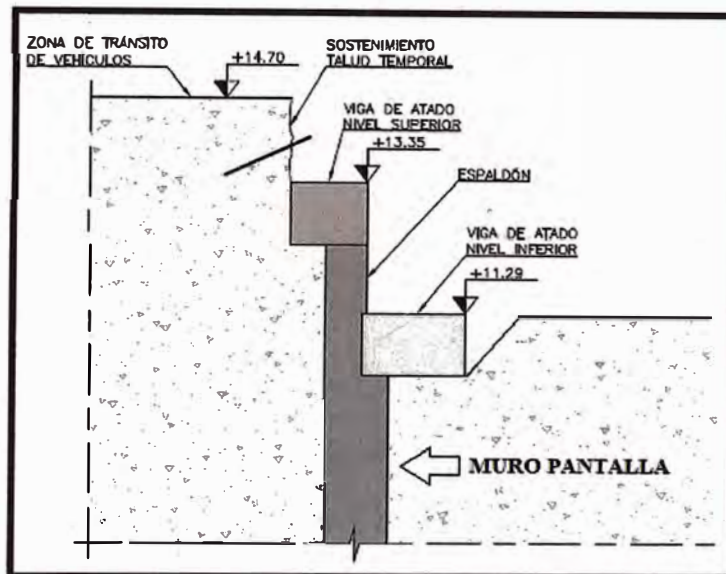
Detalle de la Viga de Atado y su empalme con el muro pantalla.
